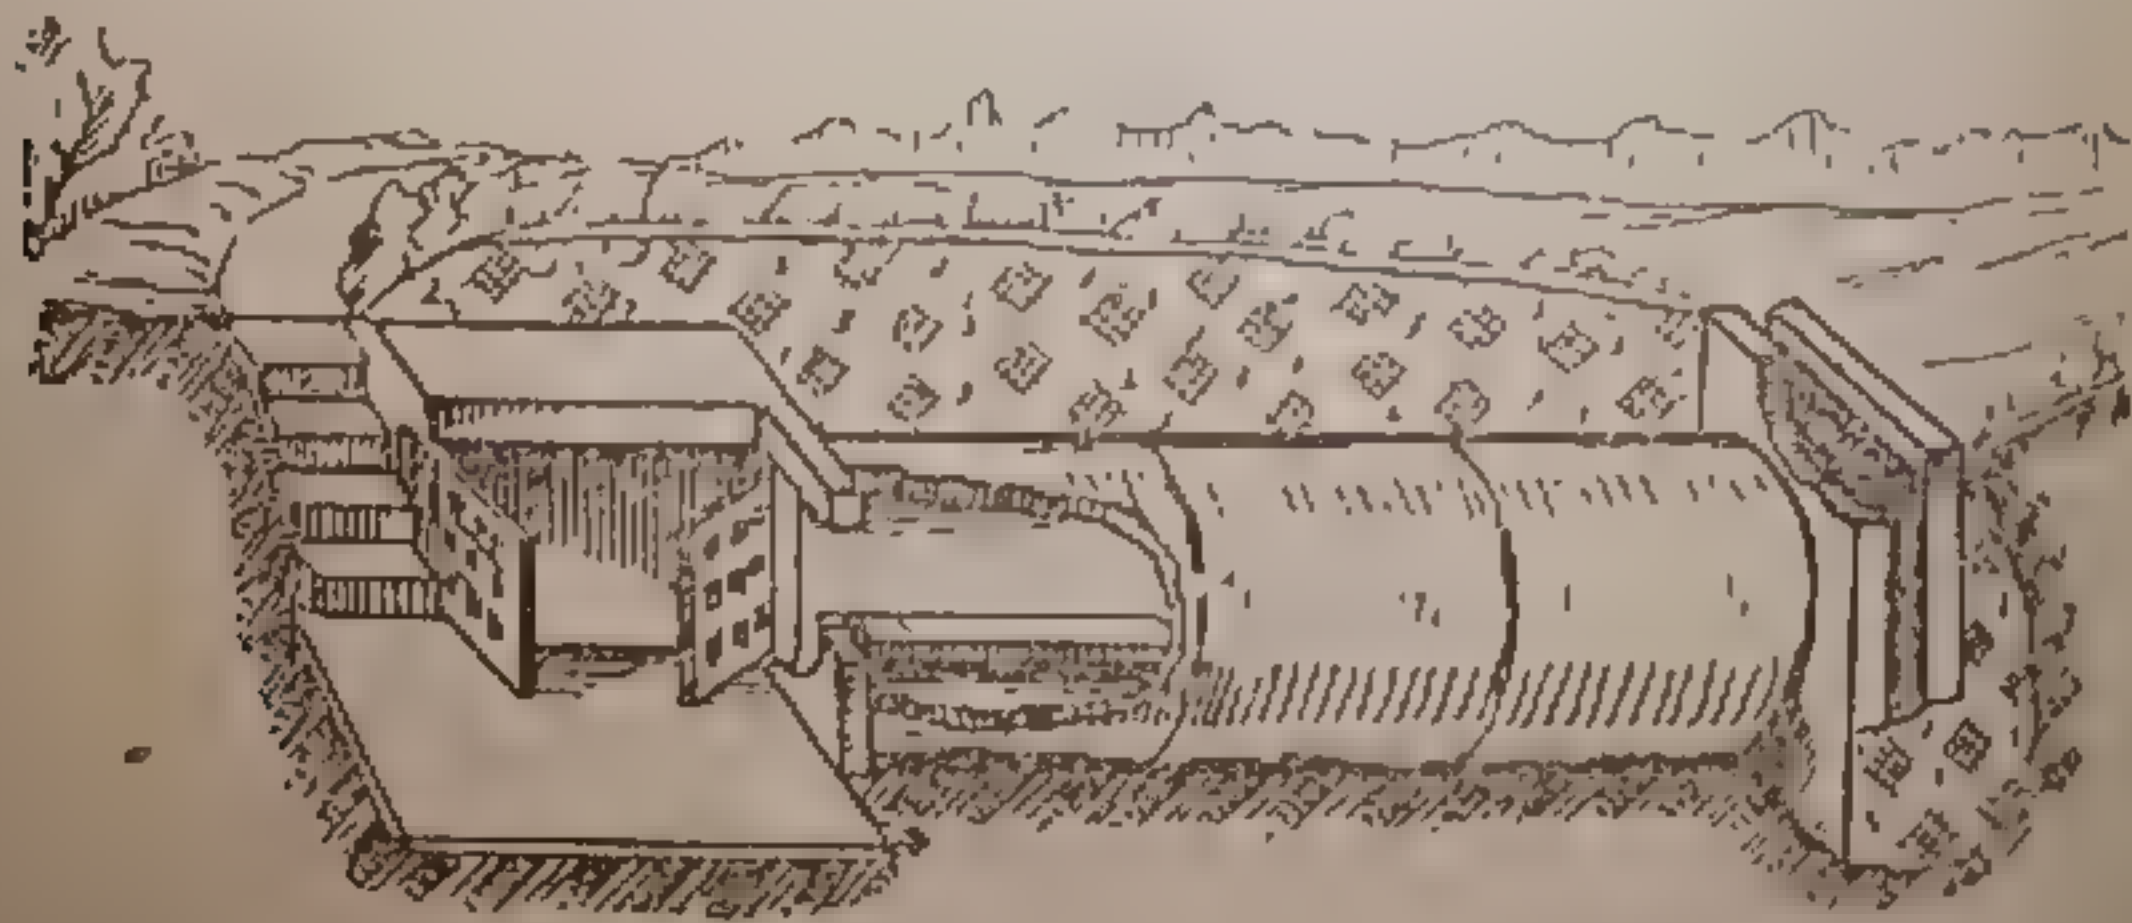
Убежище на 20 человек из железобетонных труб с упрощенным оборудованием.
